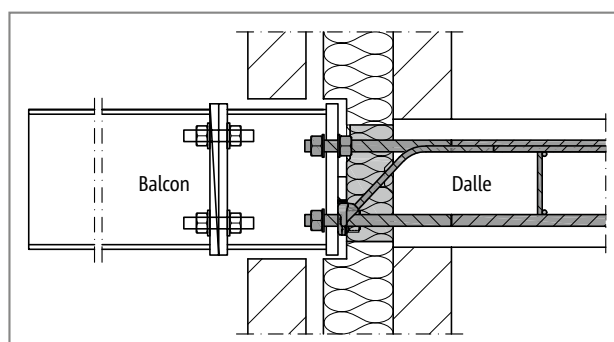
Schöck Isokorb® T type SK : Corps isolant dans l'isolation du noyau ; la pièce de liaison sur site entre l'élément Isokorb® et le balcon permet une certaine flexibilité dans le processus de construction
